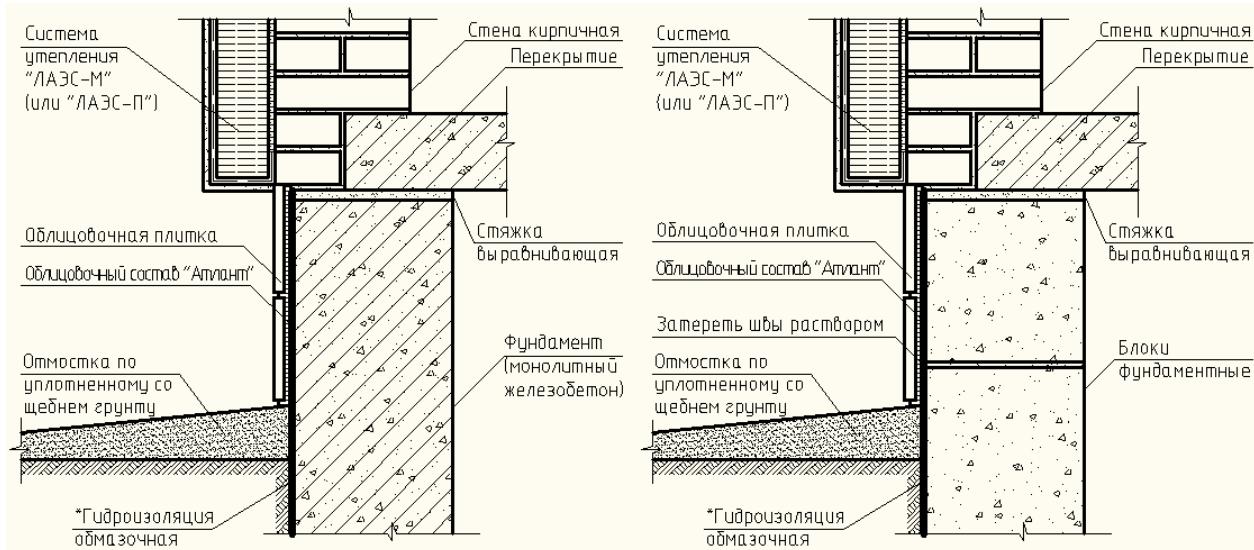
Облицовка цоколя из монолитного железобетона плиткой на облицовочном составе "Атлант" (стены утеплены)
